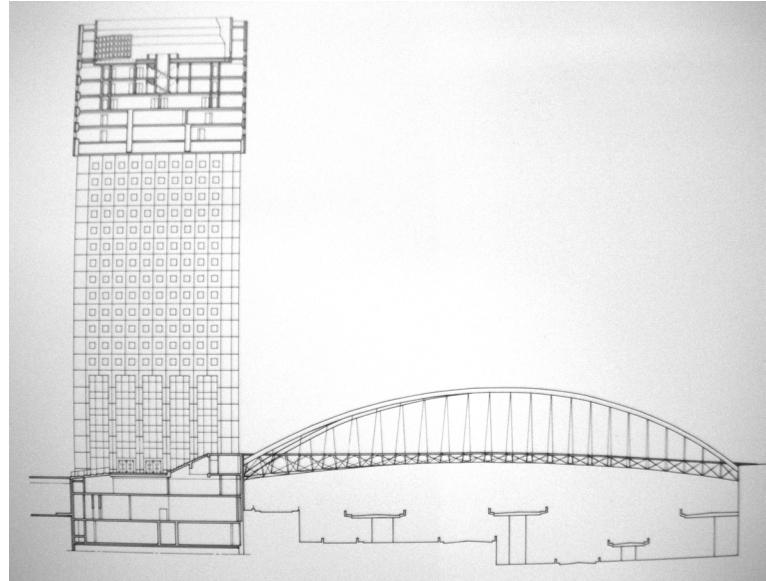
Sección del Tour Pacifiqué y su comunicación con el Japan Bridge.
